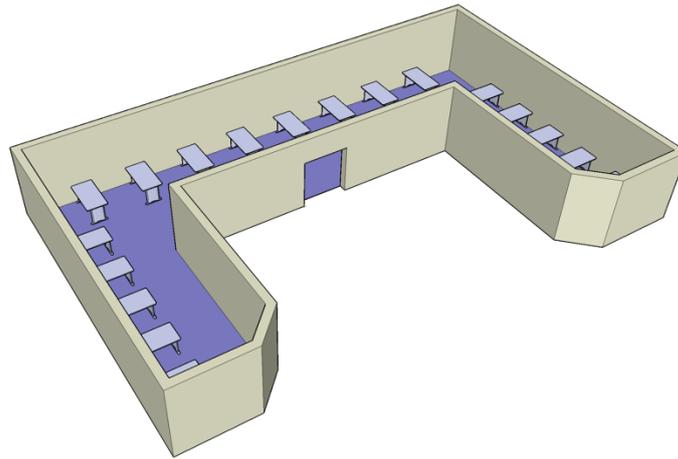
Modelo Actual en SketchUp de la planta alta del Aula de Informática de Libre Acceso
